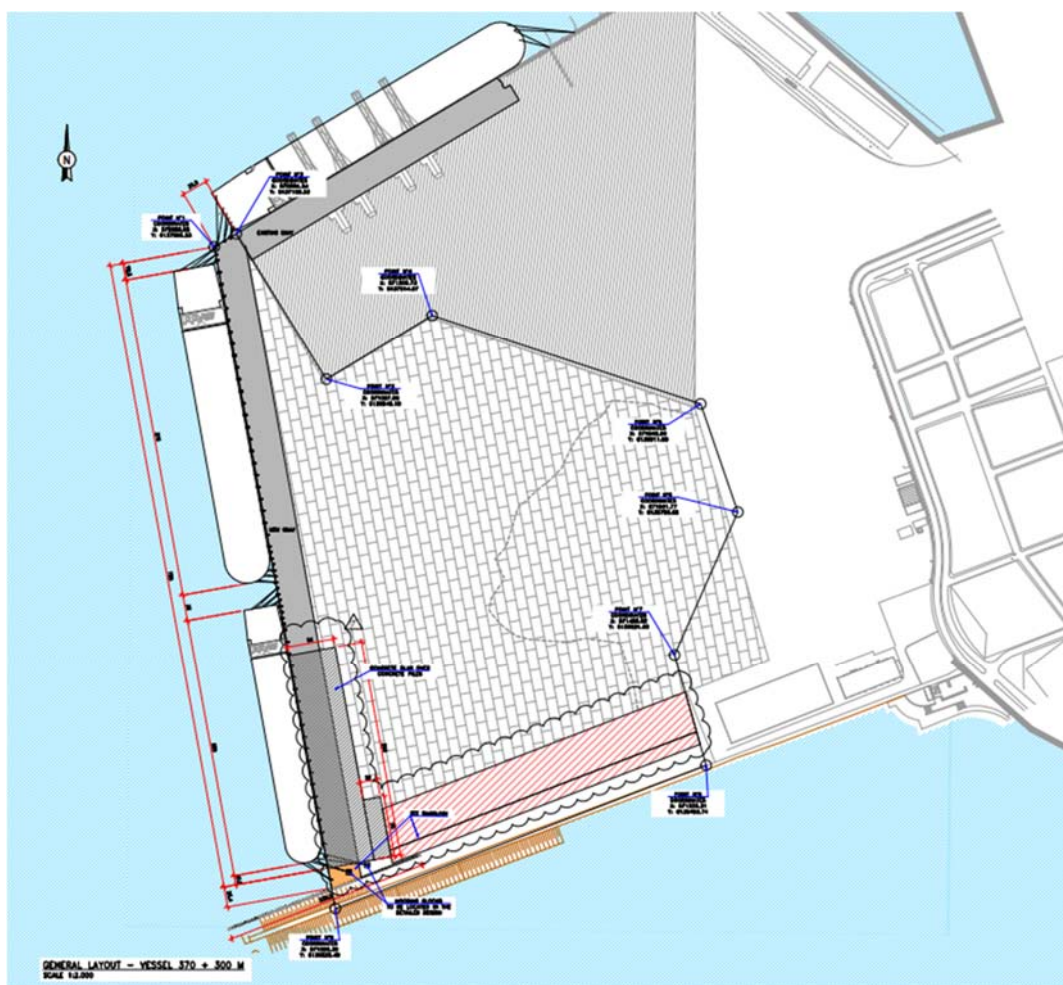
Planta general del proyecto de ampliación de TCP (Etapa V).
